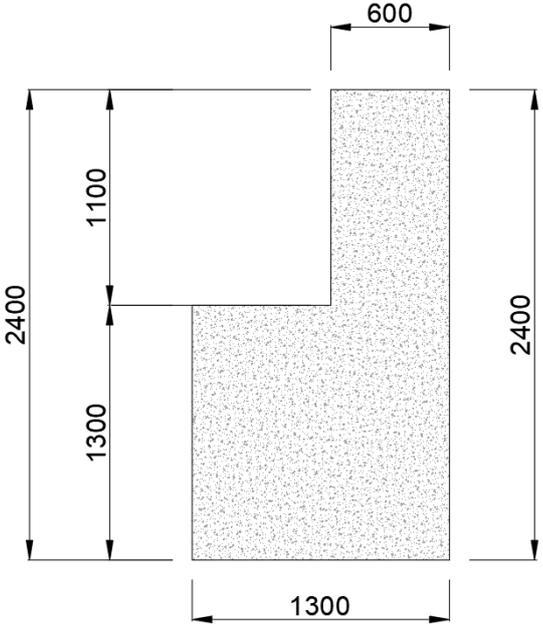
Sección transversal de la viga cabezal [Elaboración propia]
